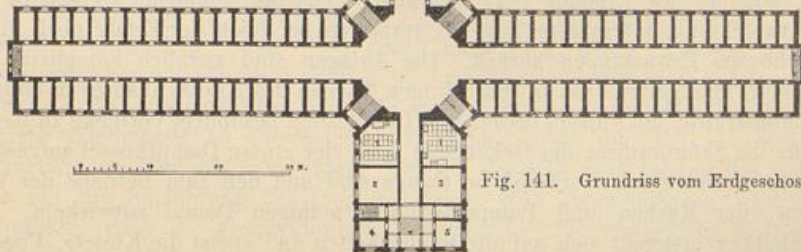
Grundriss vom Erdgeschoss.
